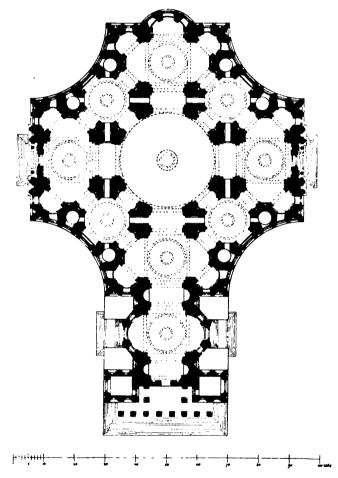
Pauls-Kathedrale zu London, Wren's erster Entwurf. Grundriss.
